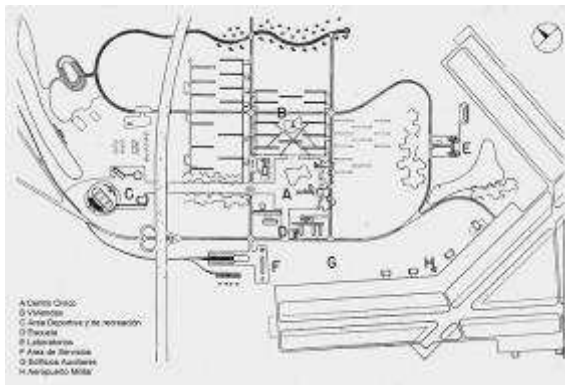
Planta de Conjunto. Fuente: BOTEY Josep Ma. Oscar Niemeyer: Obras y proyectos Works and Projects. Barcelona, España. Gustavo Gili. 2005. Figura 7: Ubicación: Fuente: Google Earth 2009.
